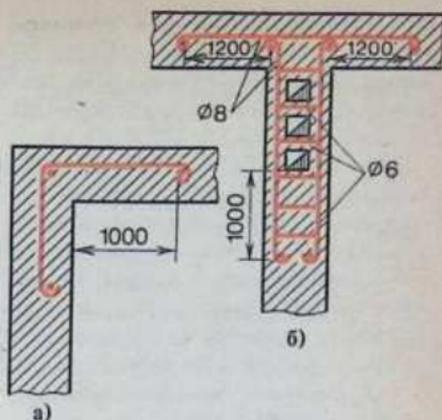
Армирование угла и примыкания внутренней стены к наружной:
